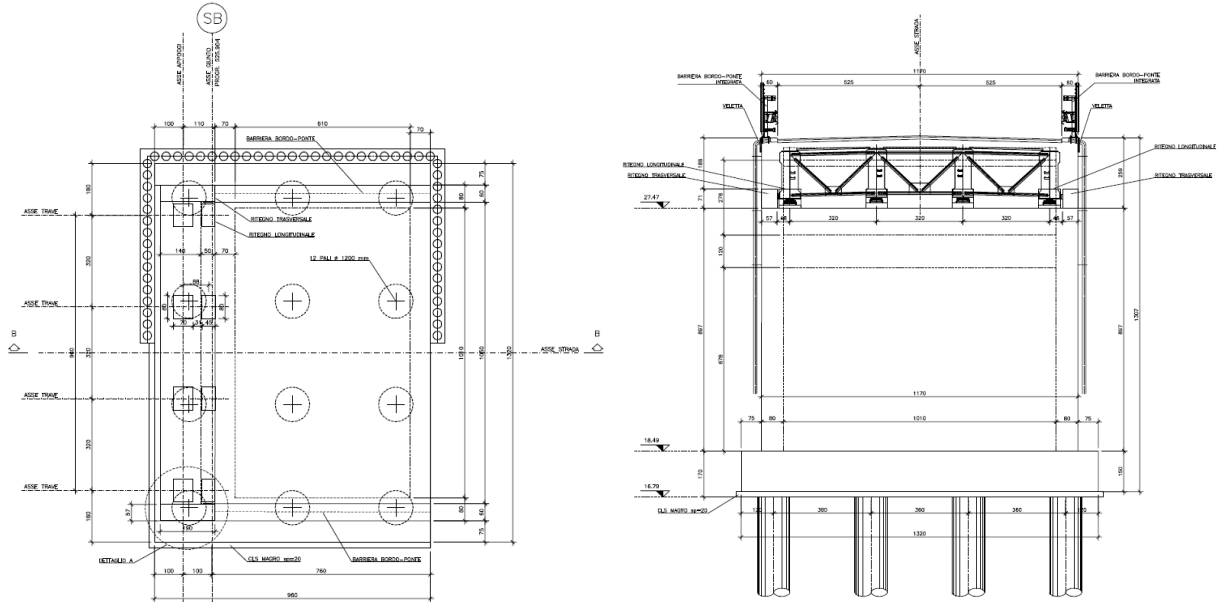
Pianta e prospetto - Spalla B
